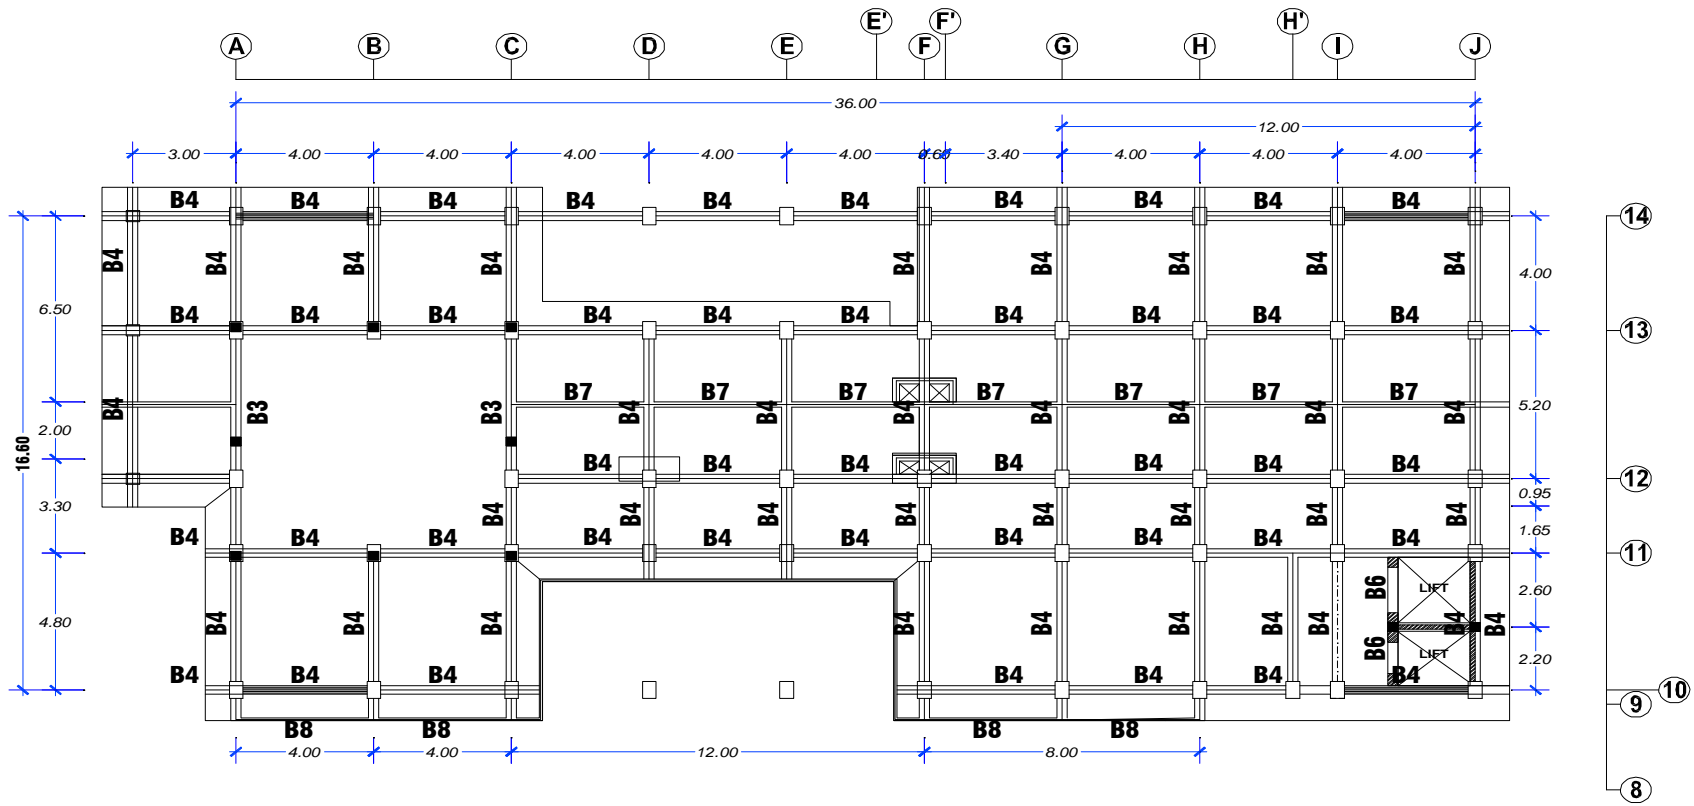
Denah Kolom Lantai 2-7 / Line 10-14
